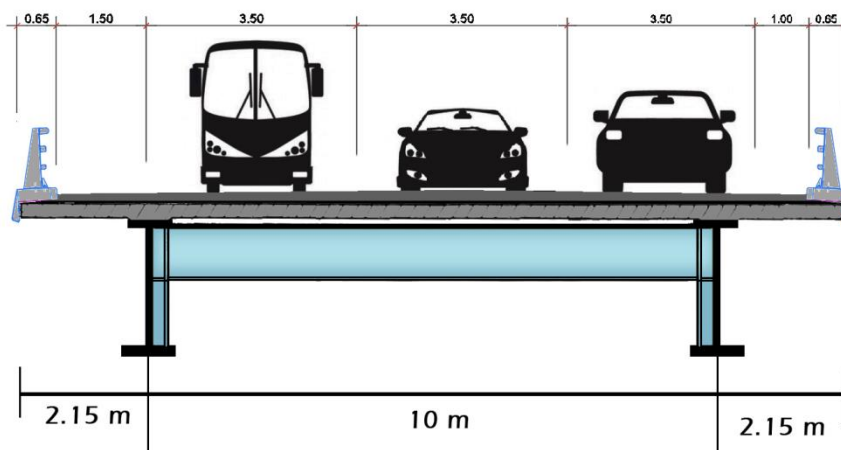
Coupe Transversale de la variante Bipoutre proposée.
